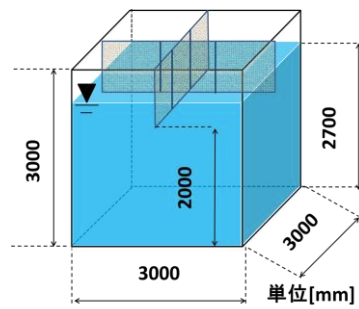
制振装置設置位置[単位 mm] 写真-3 制振装置設置状況
